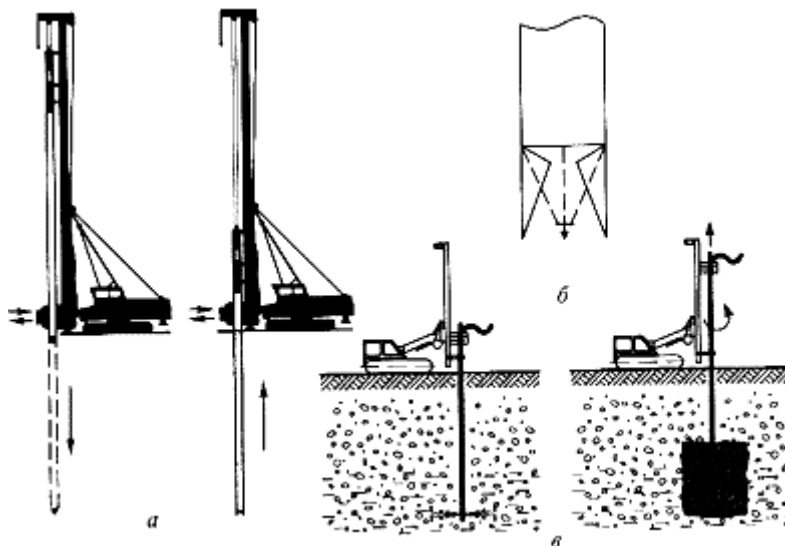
Схемы устройства грунтовых свай: а - устройство грунтопесчаных свай; б - раскрытие наконечника; в - изготовление грунтобетонных свай.
